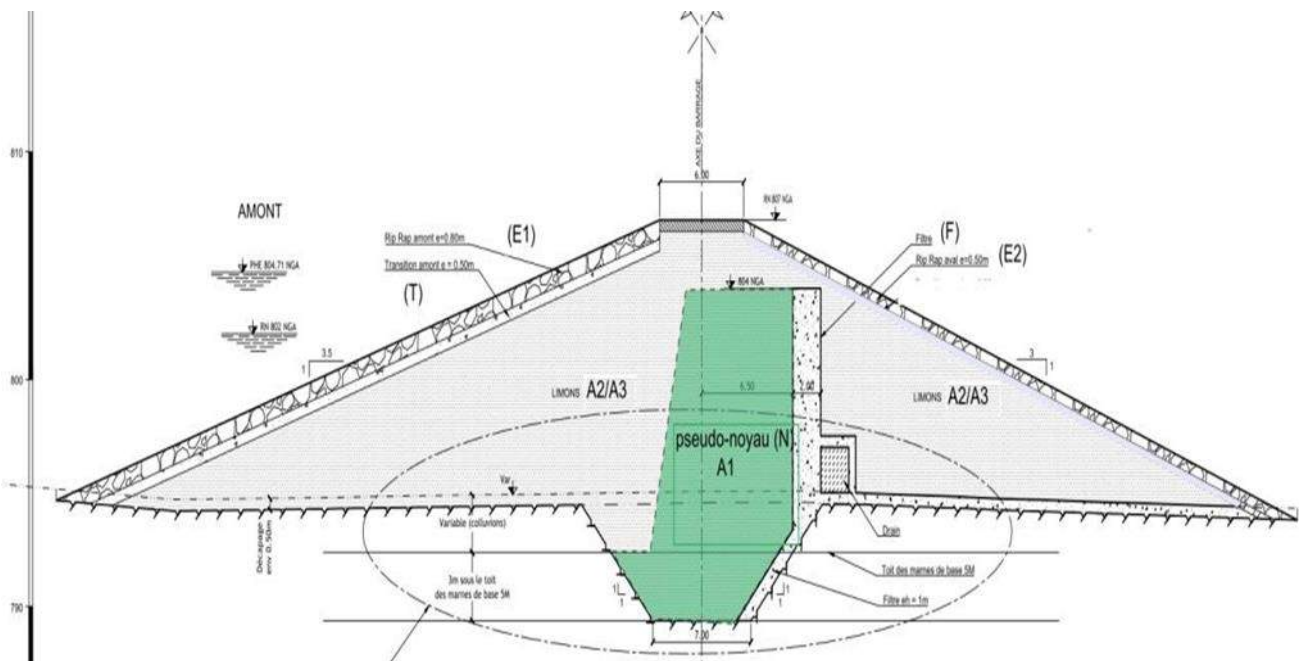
Coupe-type des ailes en remblai avec zonage détaillé
